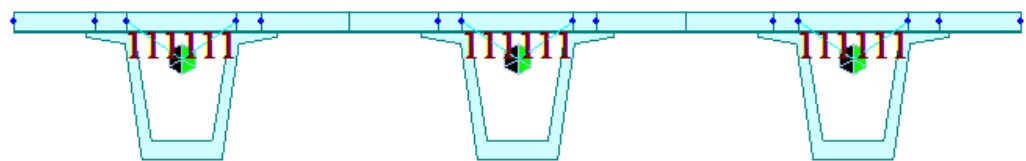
Modello FE sezione trasversale - Vista trasversale estrusa
